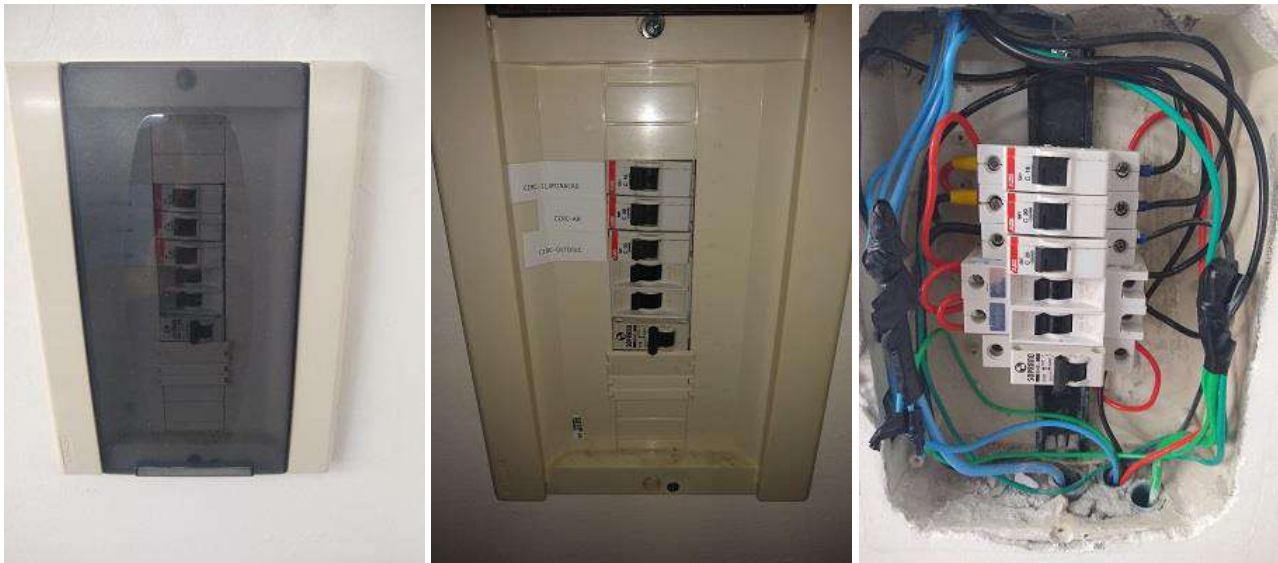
Quadro de distribuição QD15 – Pavimento 2º tipo.
